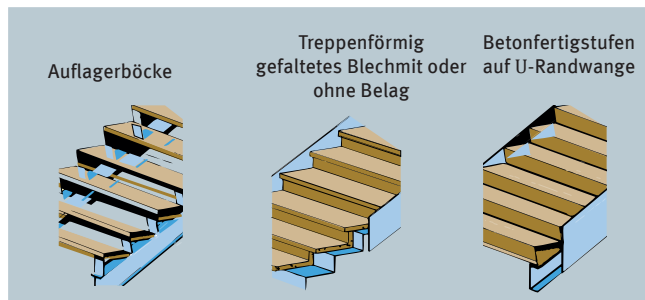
Beispiele für Treppenstufen (aus Holz, Beton, Stahlblech)
